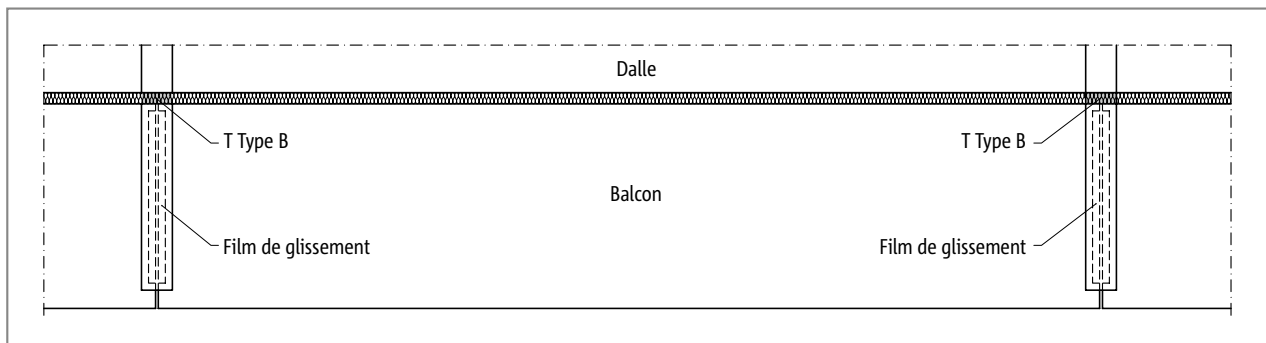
Schöck Isokorb® T Type B : Construction de balcon avec poutrelles en porte-à-faux (balcon préfabriqué)
